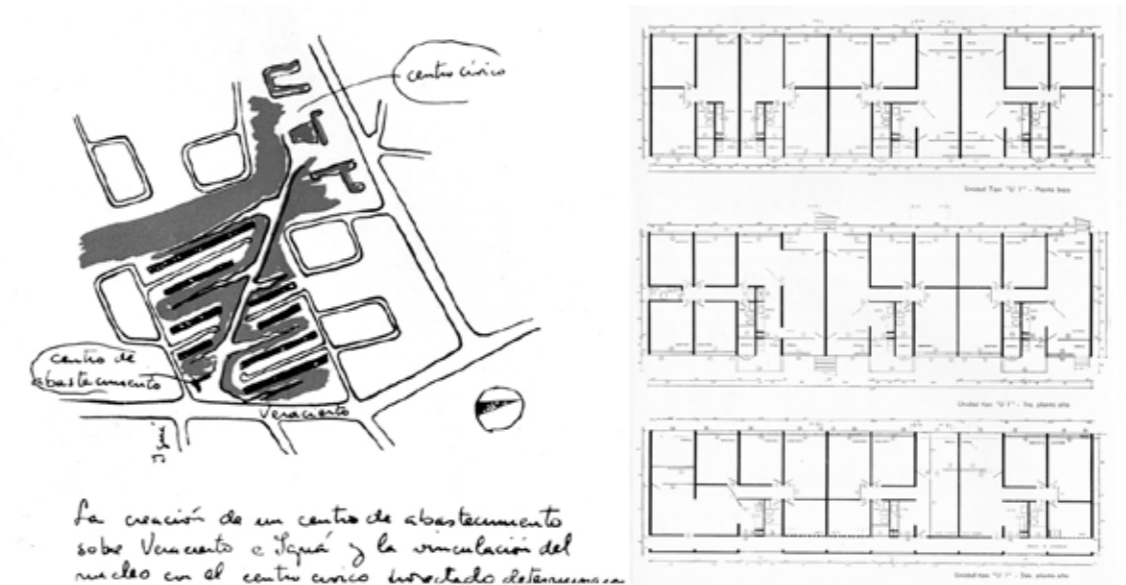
Diagrama y plantas del Barrio 16. Fuente: Arquitectura. Revista SAU 233.
